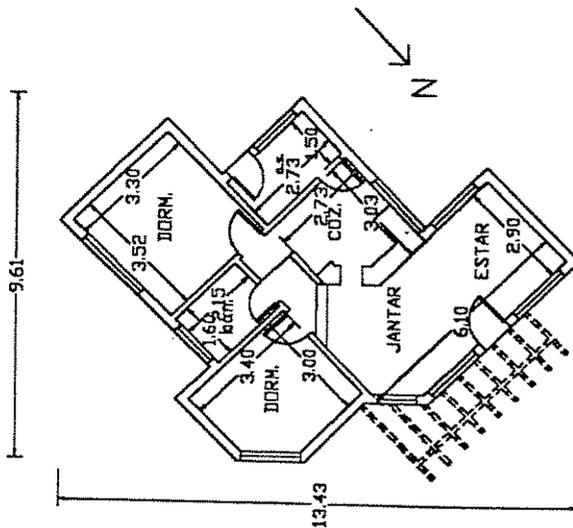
Planta baixa da Edificação 01. Fonte: Elaboração própria.
